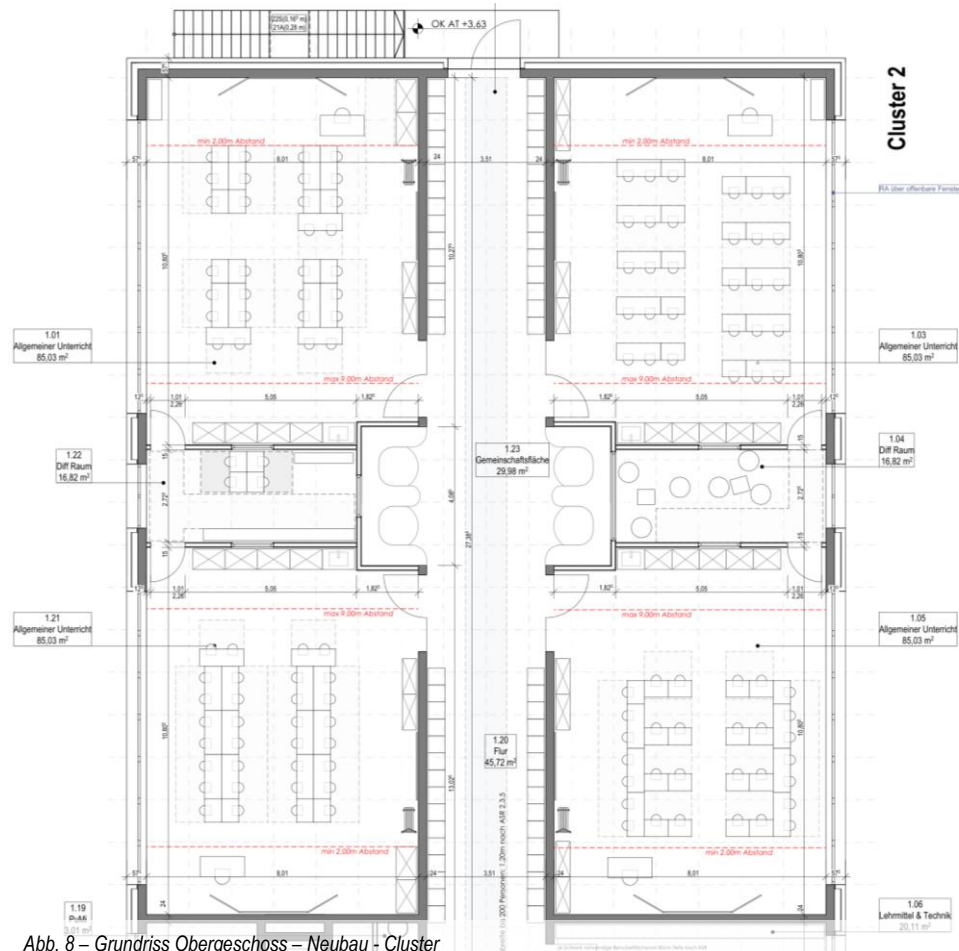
Grundriss Obergeschoss – Neubau - Cluster
